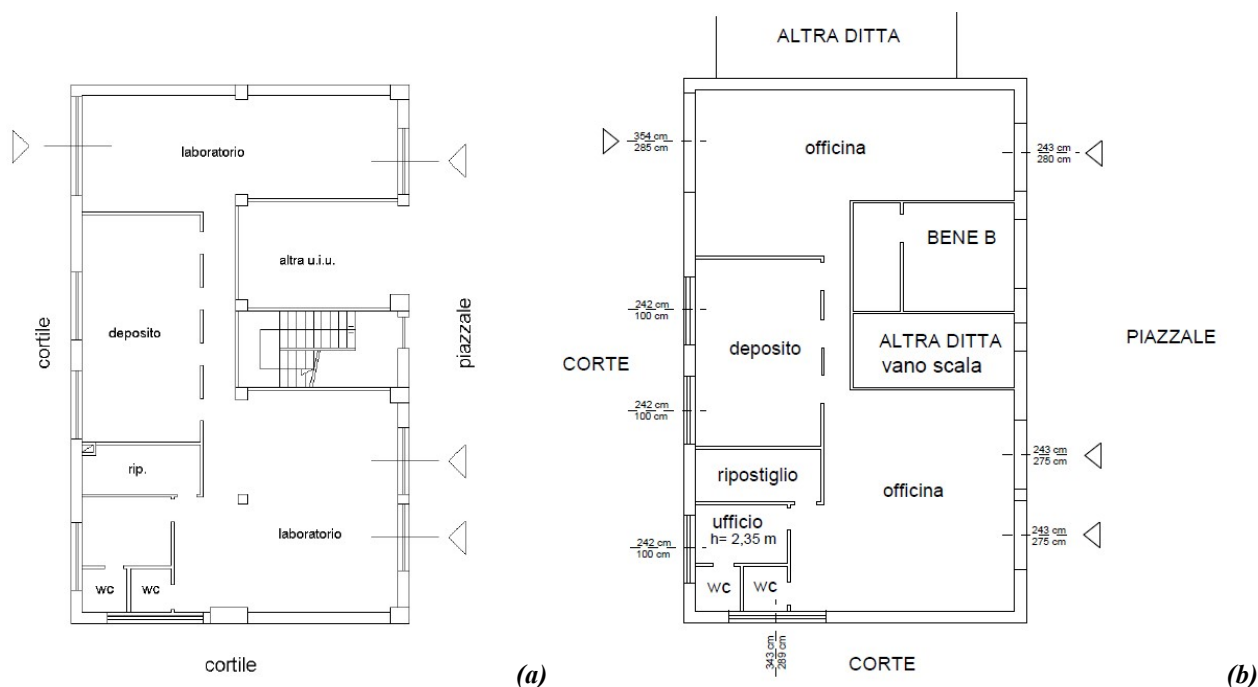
Planimetrie del Bene A ubicato in via Napoli n° 27-29-35: planimetria catastale (a); planimetria attuale (b).
